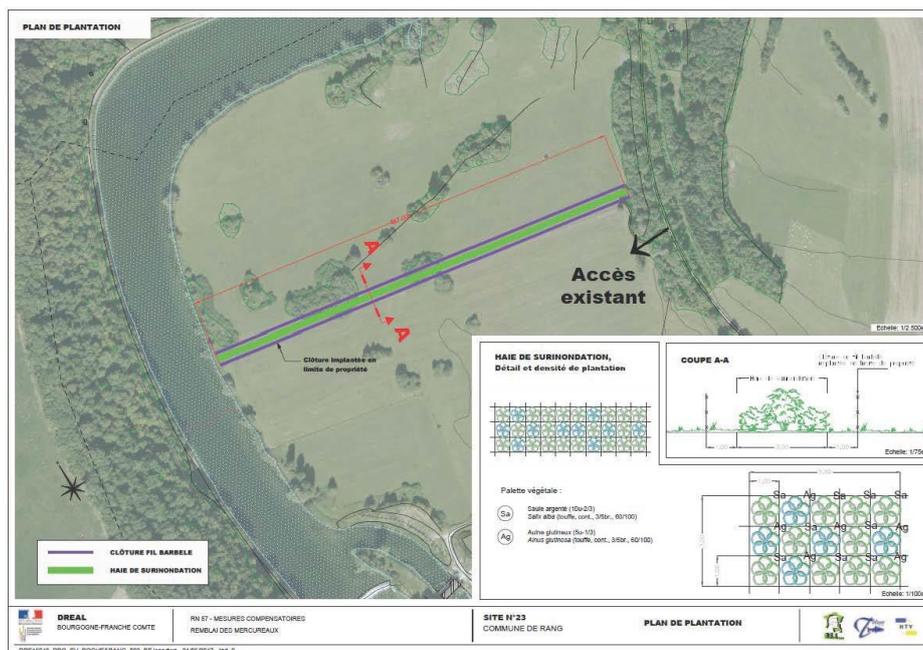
Plan de plantation de la haie à Rang. Source : dossier.
